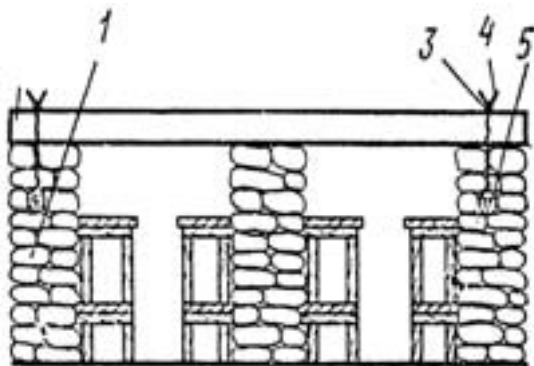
Поперечний розріз сховища зі стінами із ґрутонабивних мішків:
